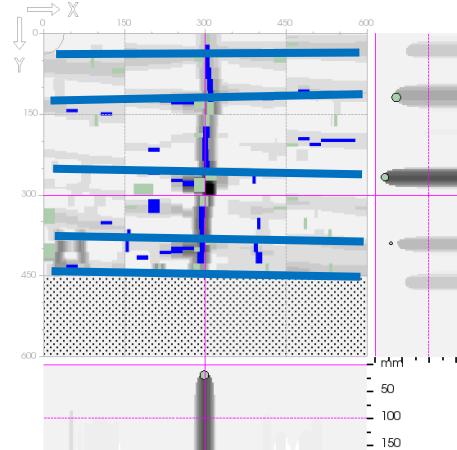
Poutre Pt03 – Travée 2 à mi-travée
